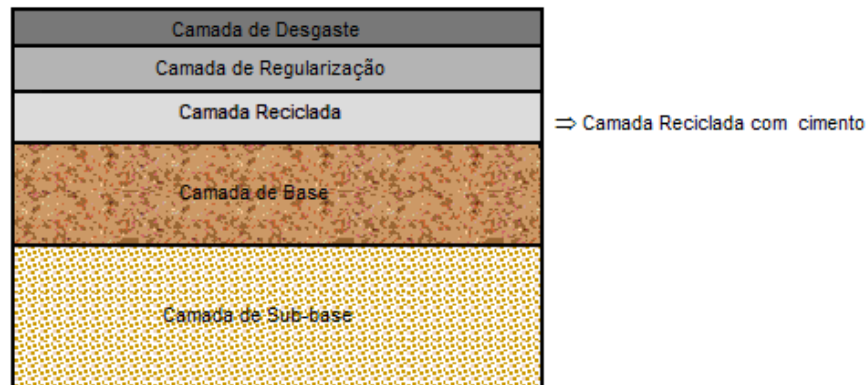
Estrutura de um pavimento reciclado *in situ* a frio com cimento
